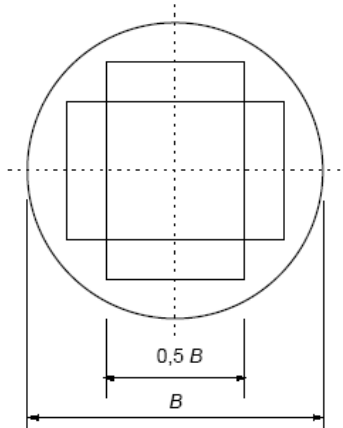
Orthogonale Bewehrung in Kreisfundamenten im Boden
